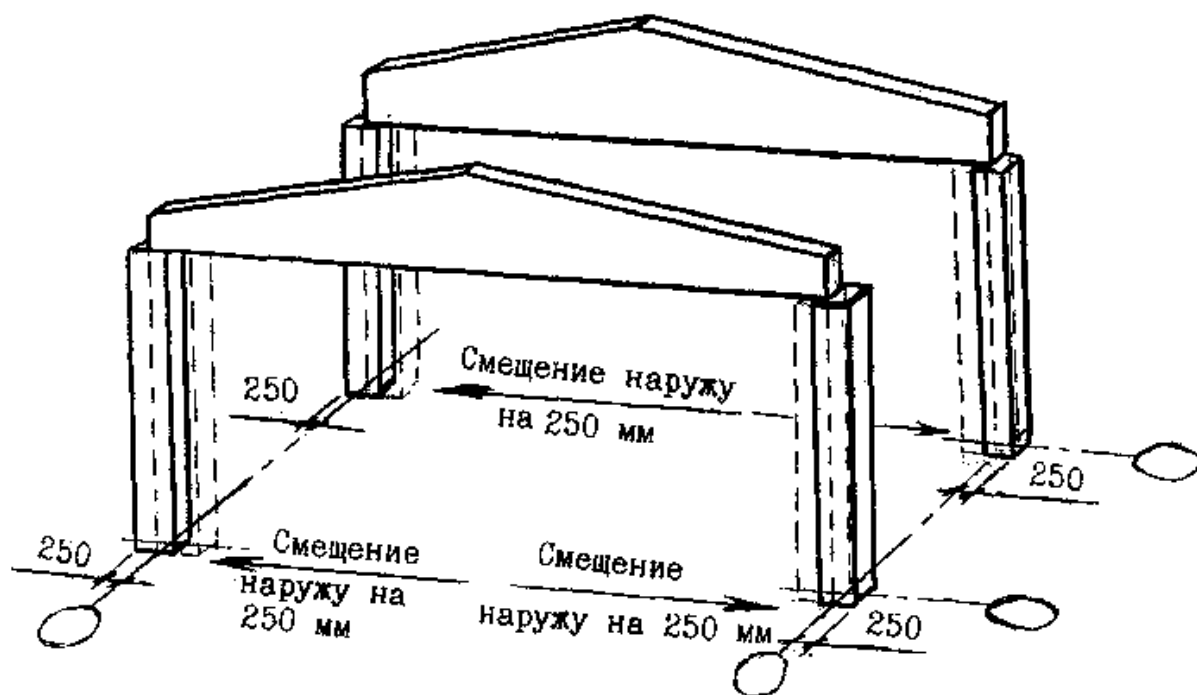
Схема смещения колонн каркаса при использовании привязки «250»
